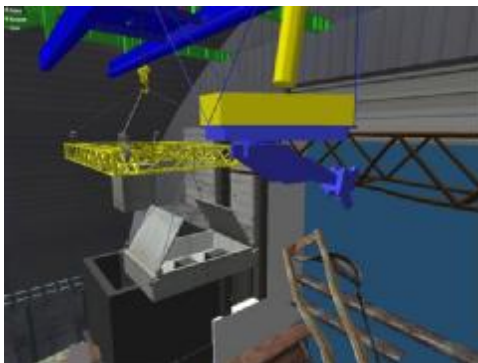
Демонтаж ферм покрівлі та площадок обслуговування вузла розв'язки на східній стіні ЦЗ.
